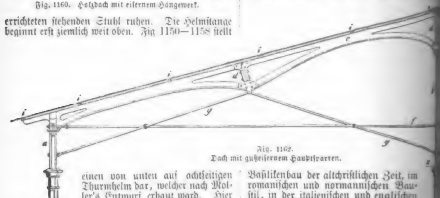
Dach mit gusseisernem Hauptsparren.
